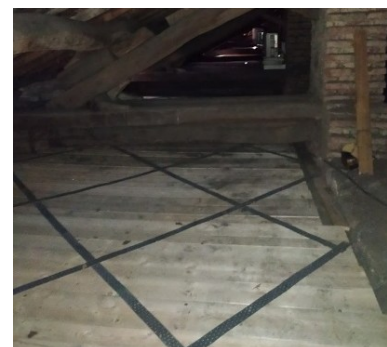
nuovo assito in legno e bandelle metalliche inchiodati al solaio di sottotetto (lavori di Studio Calvi BEAM BEAM)
